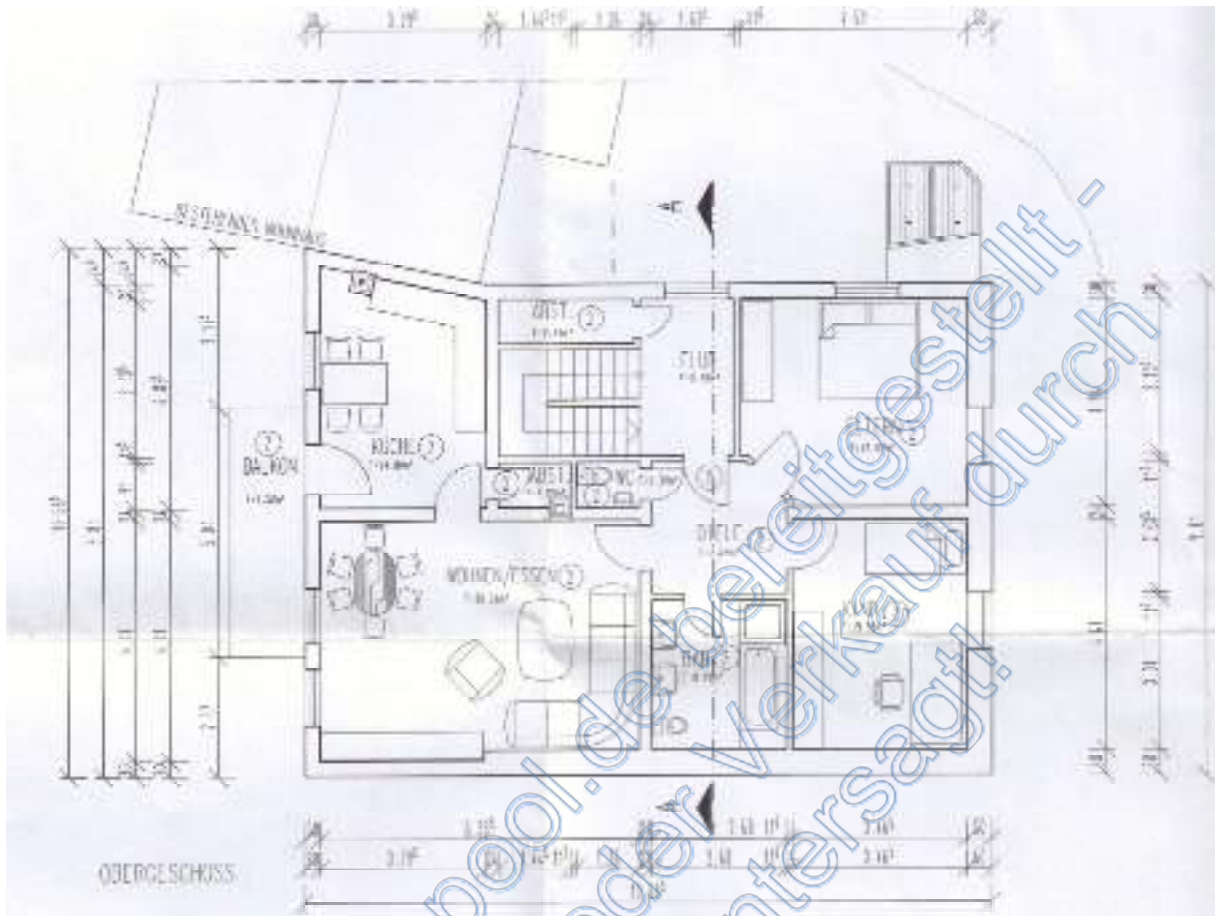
Grundriss des Bewertungsobjekts (Sondereigentum im 1.Obergeschoss) aus den Aufteilungsplänen. Altbau als „bestehendes Wohnhaus“ markiert. (ohne Maßstab)
